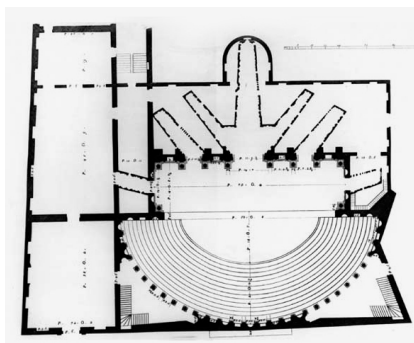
Planta do Teatro Olímpico, Palladio.
